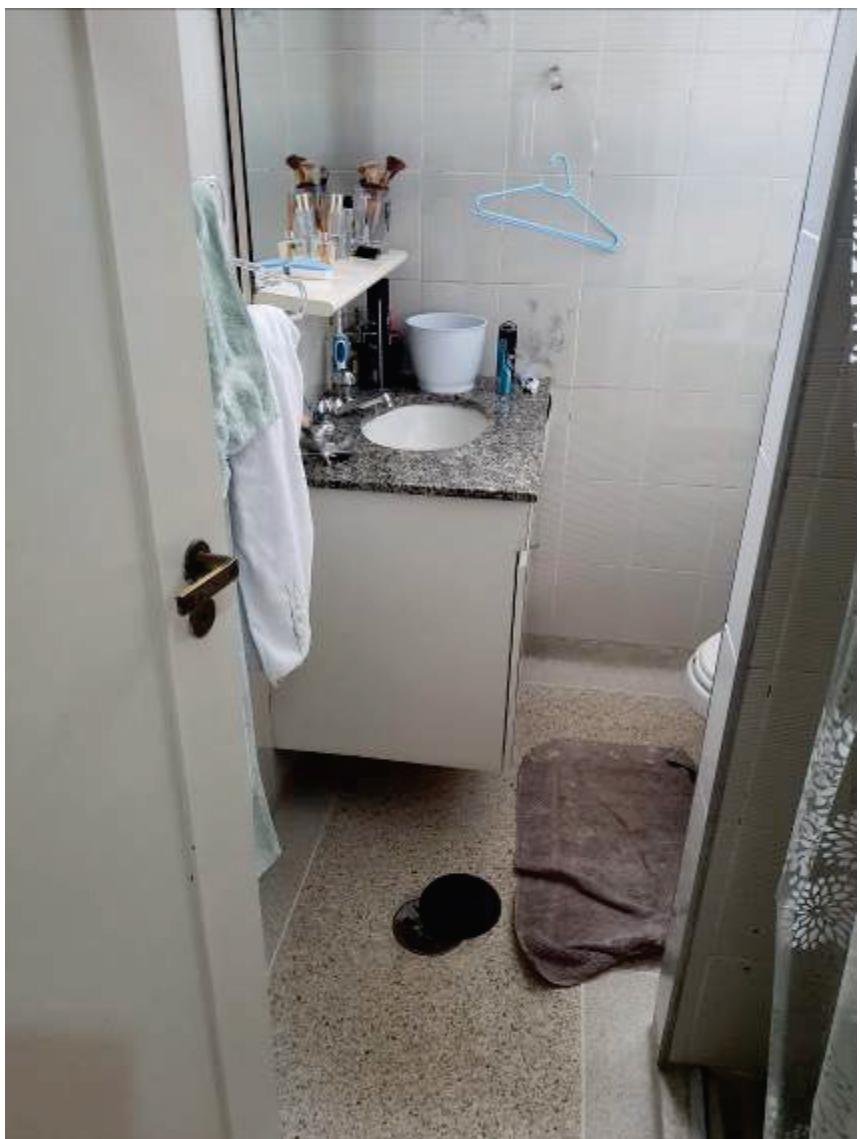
VISTA DO BANHO DA SUÍTE REFORMADA PELA REQUERIDA.
